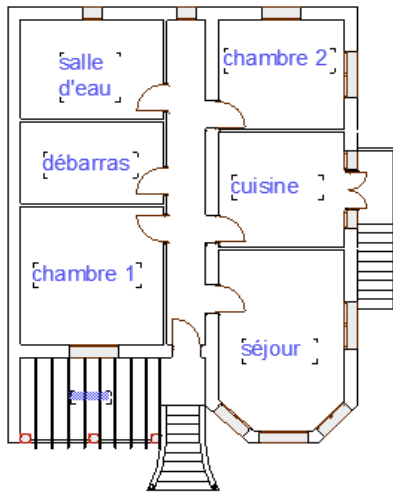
PLAN DE LA MAISON AGRICOLE
